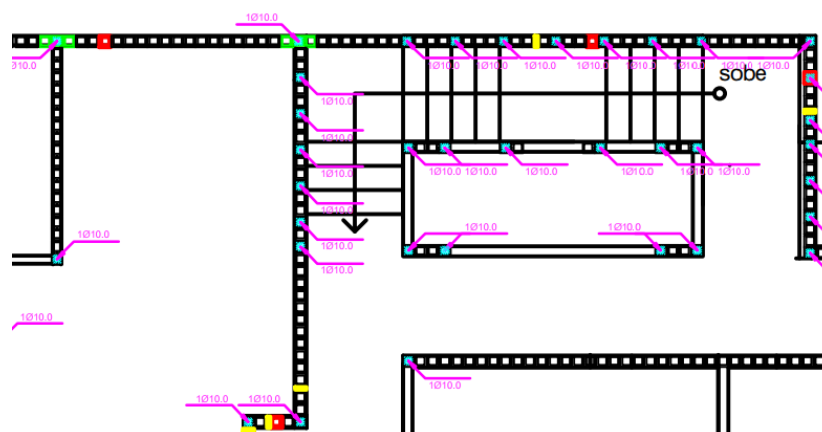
REPRESENTAÇÃO DE UMA PLANTA DE PAGINAÇÃO DE UMA ALVENARIA ESTRUTURAL
